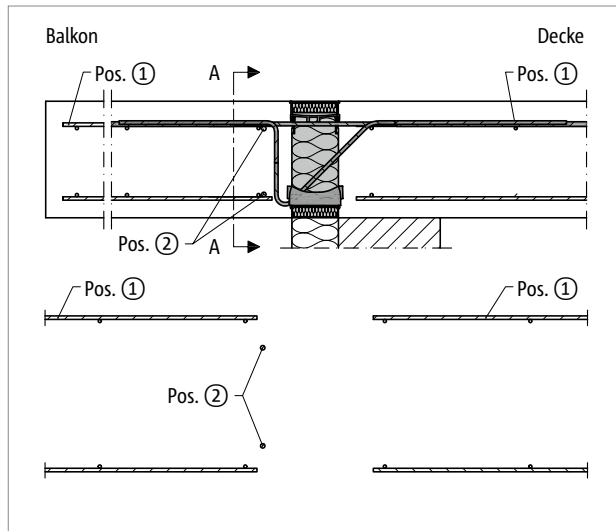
Schöck Isokorb® T Typ KL: Bauseitige Bewehrung bei direkter Lagerung
